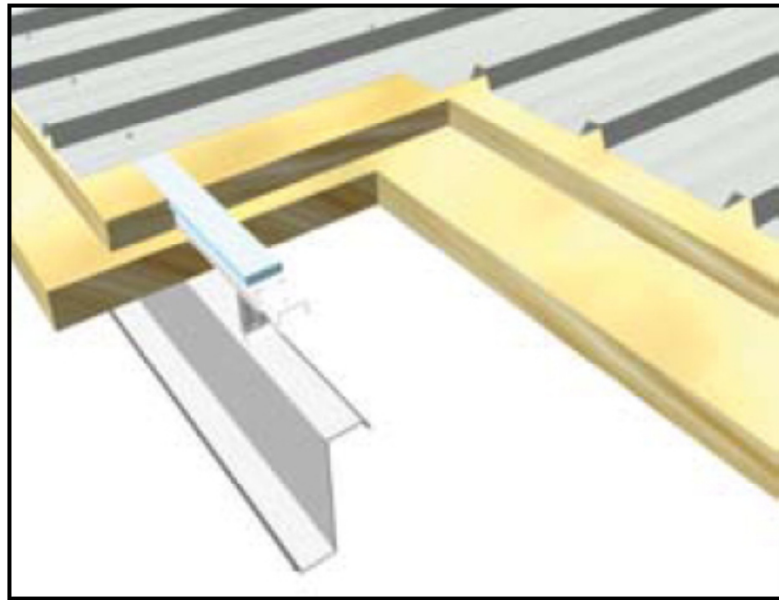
Roof System - TIPO 4: Single Skin Bridge Roof
